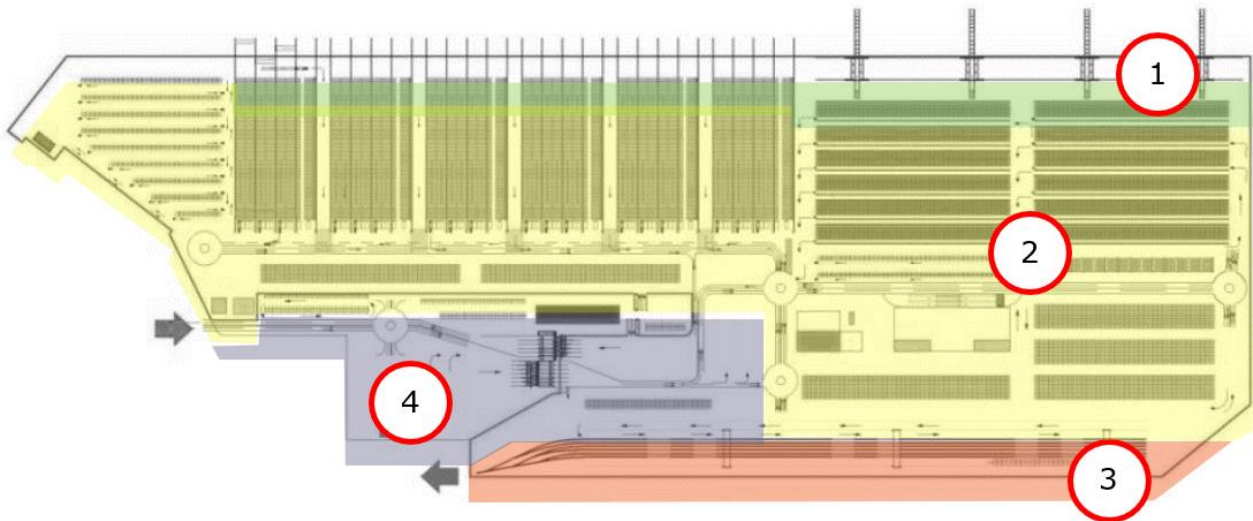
Layout progettuale del progetto approvato nel 2013 – Terminale container Onshore
